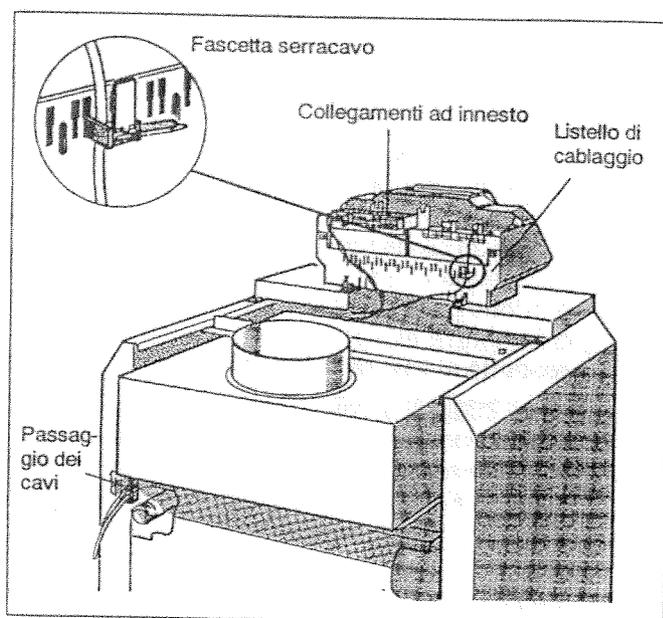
Collegamenti ad innesto e fascetta serracavo
